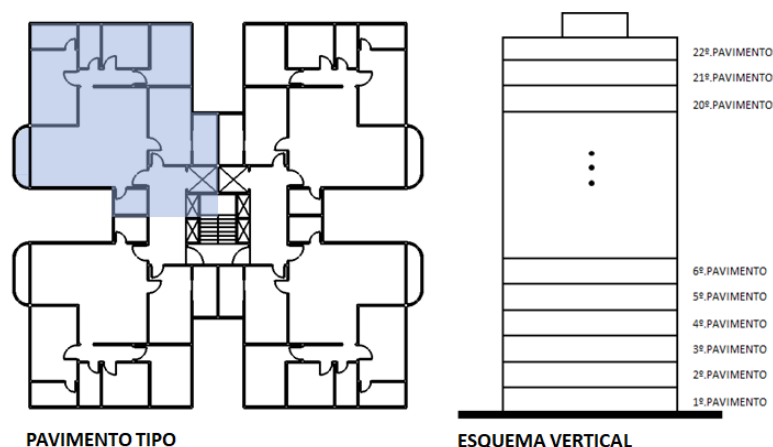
Planta do pavimento tipo e esquema vertical do edifício do apartamento estudado
